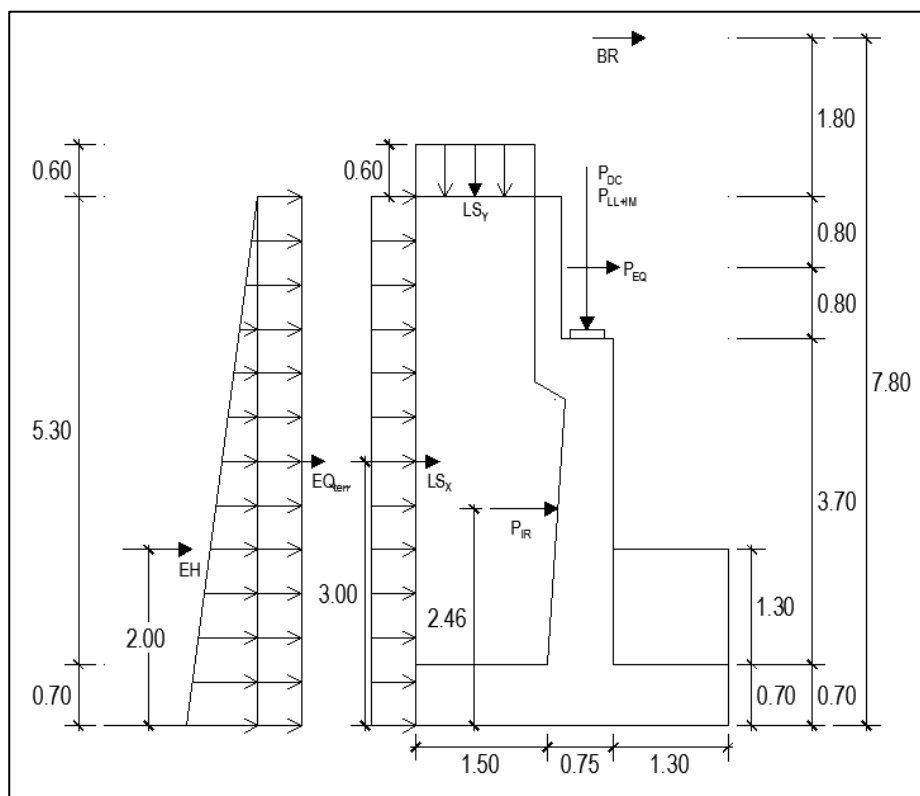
Cargas horizontales y verticales aplicadas al estribo.
